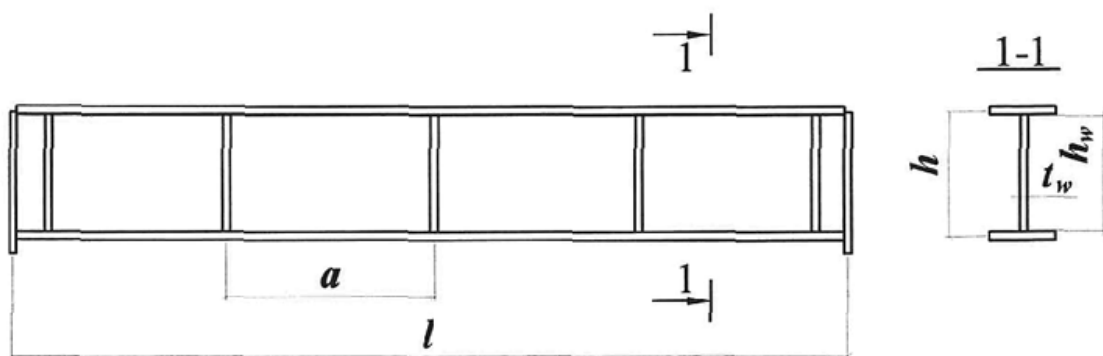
Сварной двутавр с поперечными ребрами типа «Канск»
